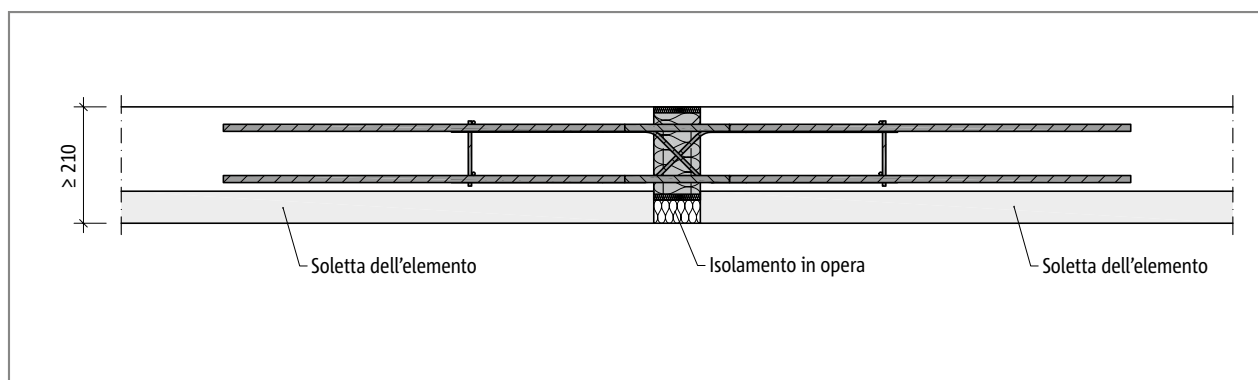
Schöck Isokorb® T tipo DL: solaio prefabbricato con Isokorb® T tipo DL sovrapposto
